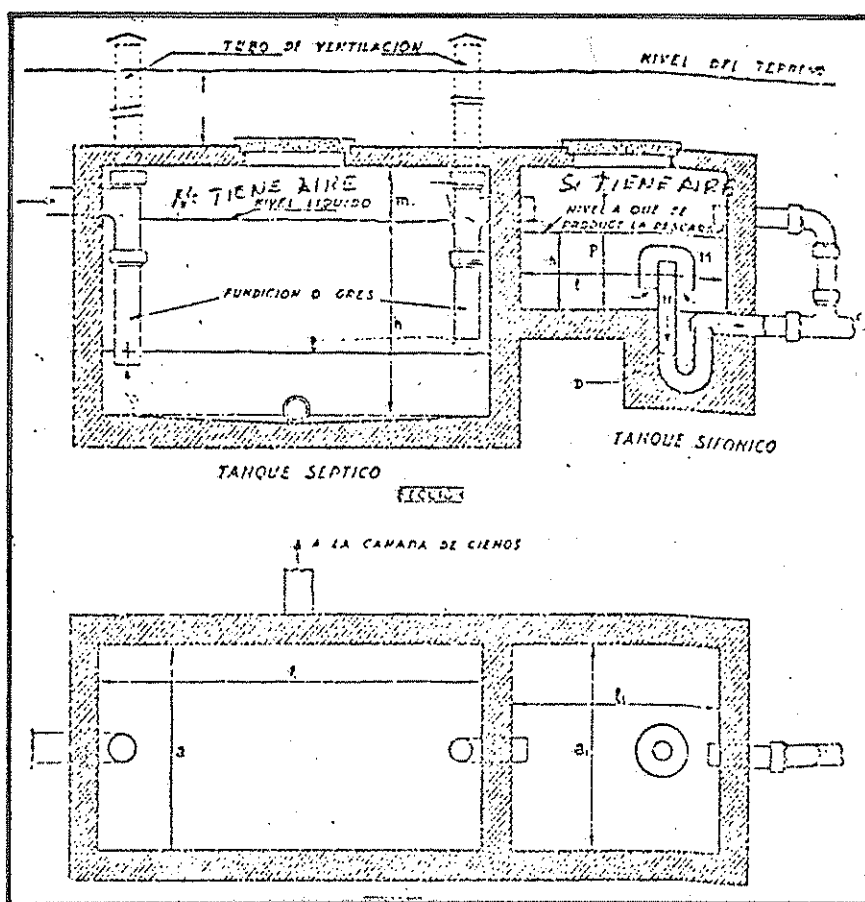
Tanque séptico y tanque sifónico: planta y sección.
